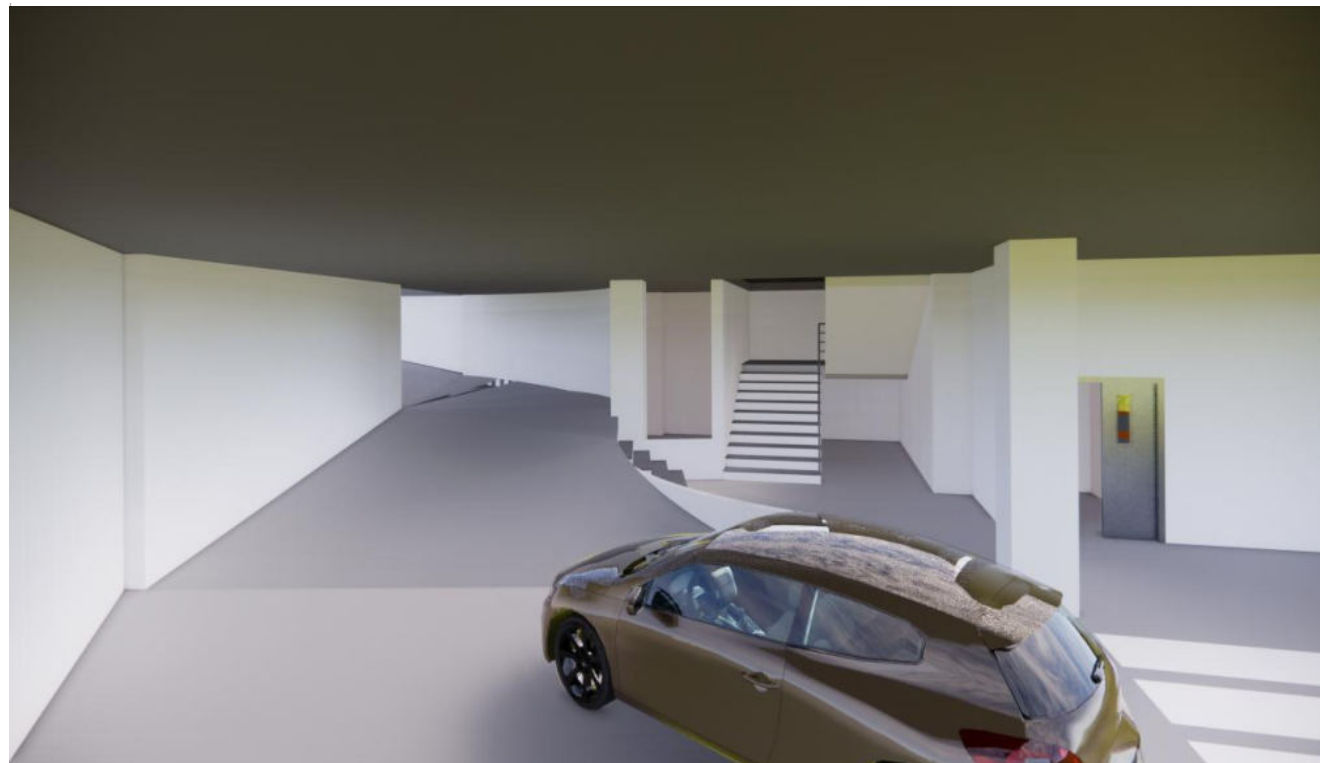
Vista interior parqueadero subterráneo Nv-4.10. Propuesta arquitectónica. Fuente: Elaboración propia, 2021.
